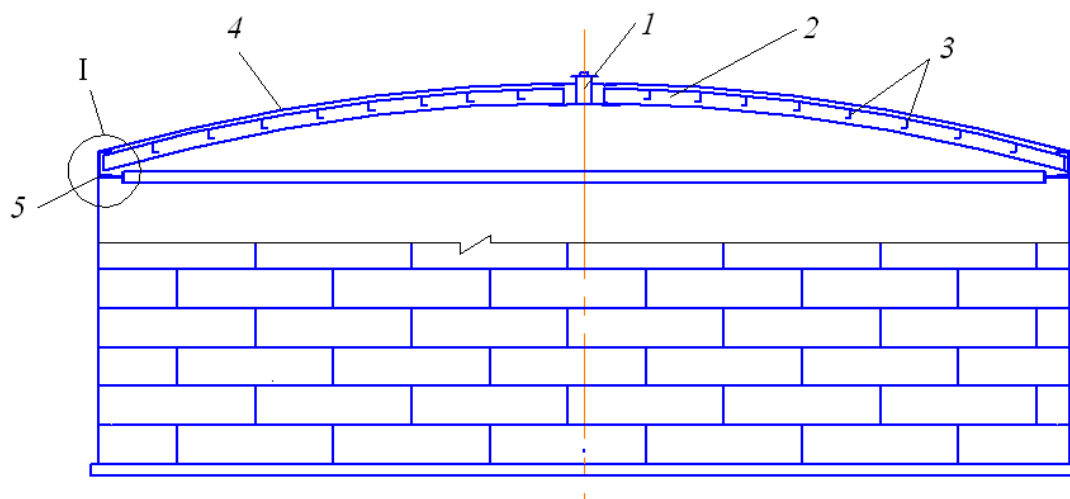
Конструкция вертикального резервуара со сферической крышей:
